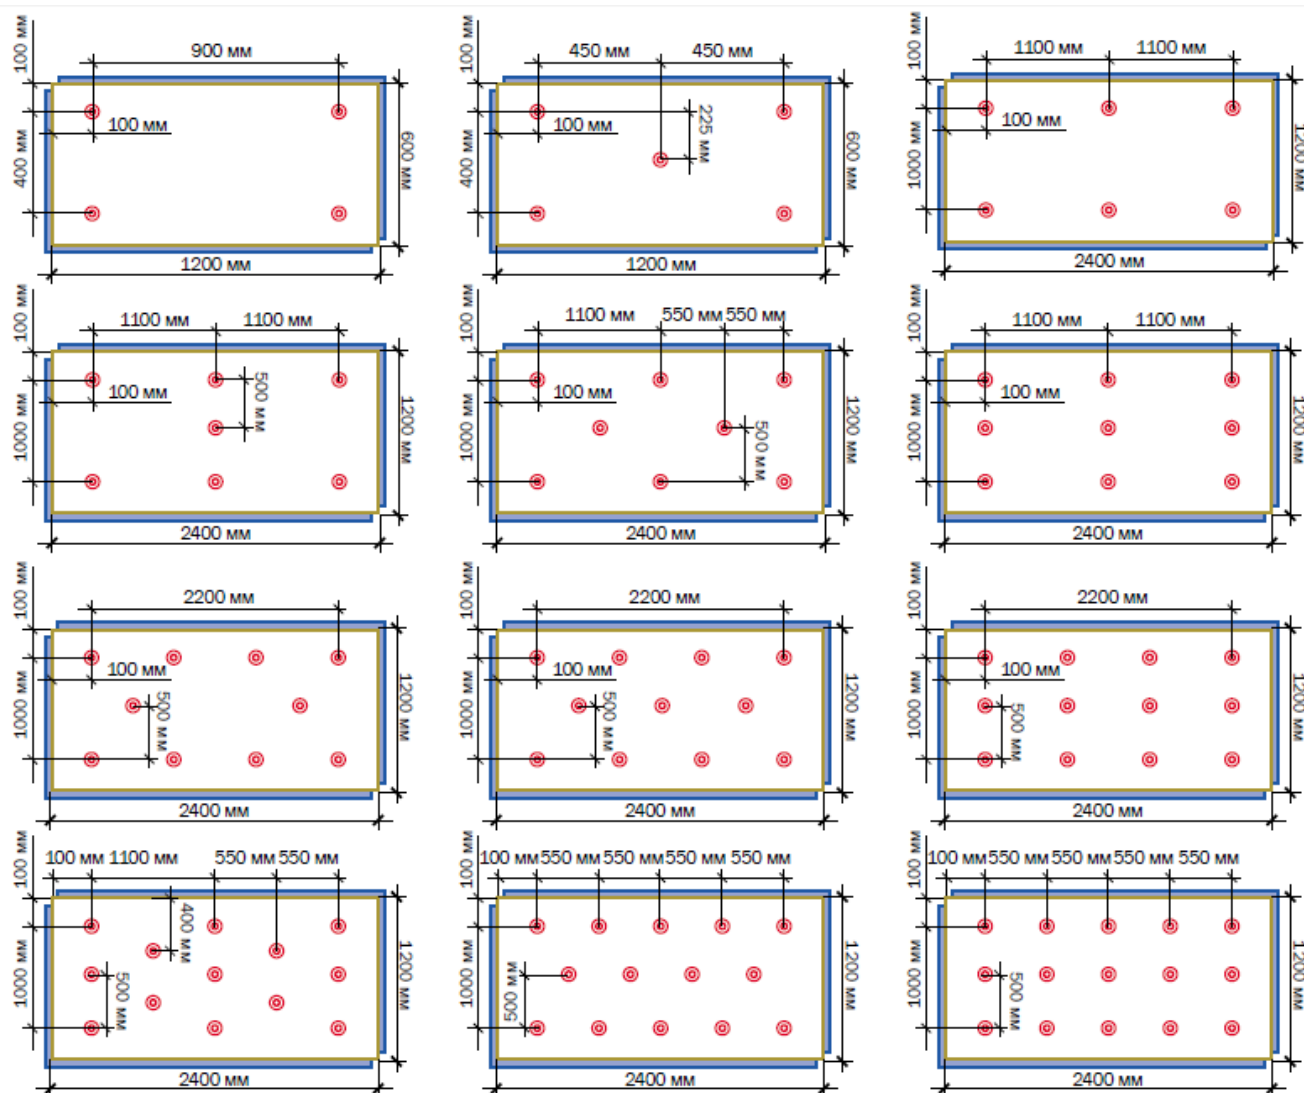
Рекомендуемая схема крепления плит теплоизоляционных PIR
